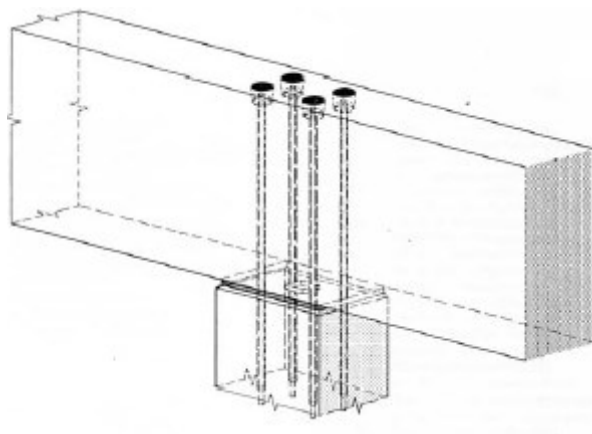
Modelo de ligação pilar – viga com pré-esforço (STUPRÉ, 1981).
